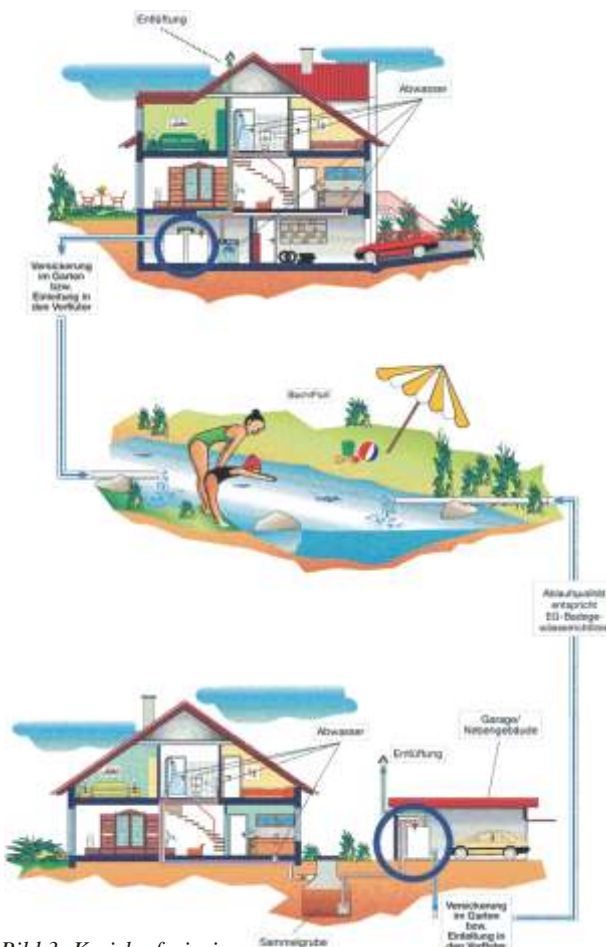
Kreislaufprinzip Einbau der Mikrofiltrationsanlage BUSSE-MF
